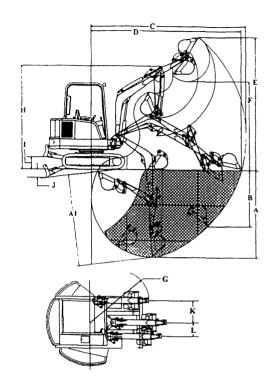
Размеры забоя мини-экскаваторов, оборудованных обратной лопатой
